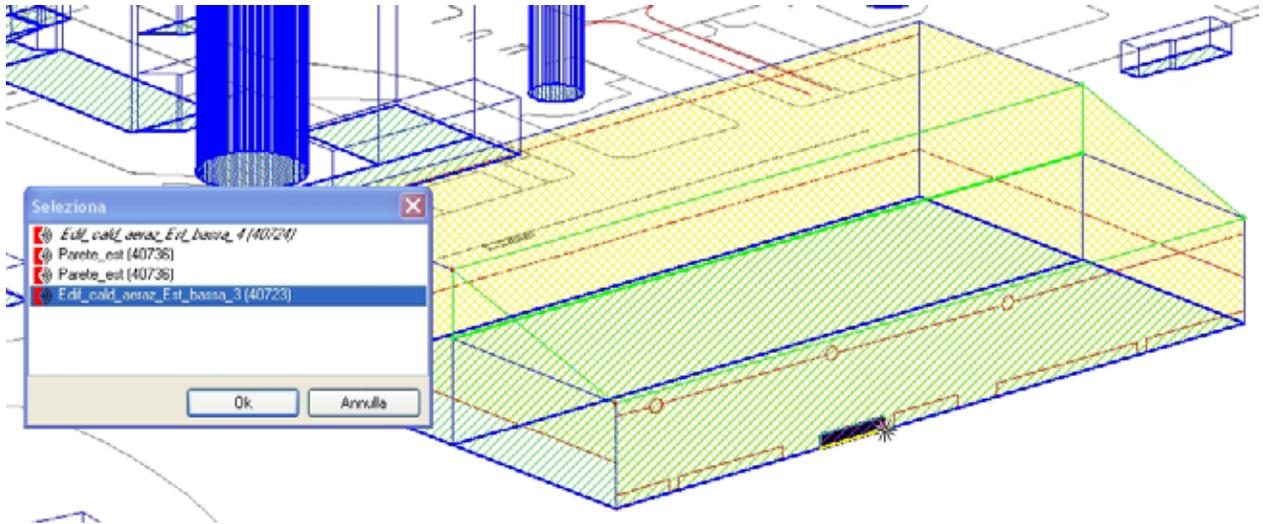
Nuovo edificio generatori di calore, porzione 3 ventilazione parete Est.
